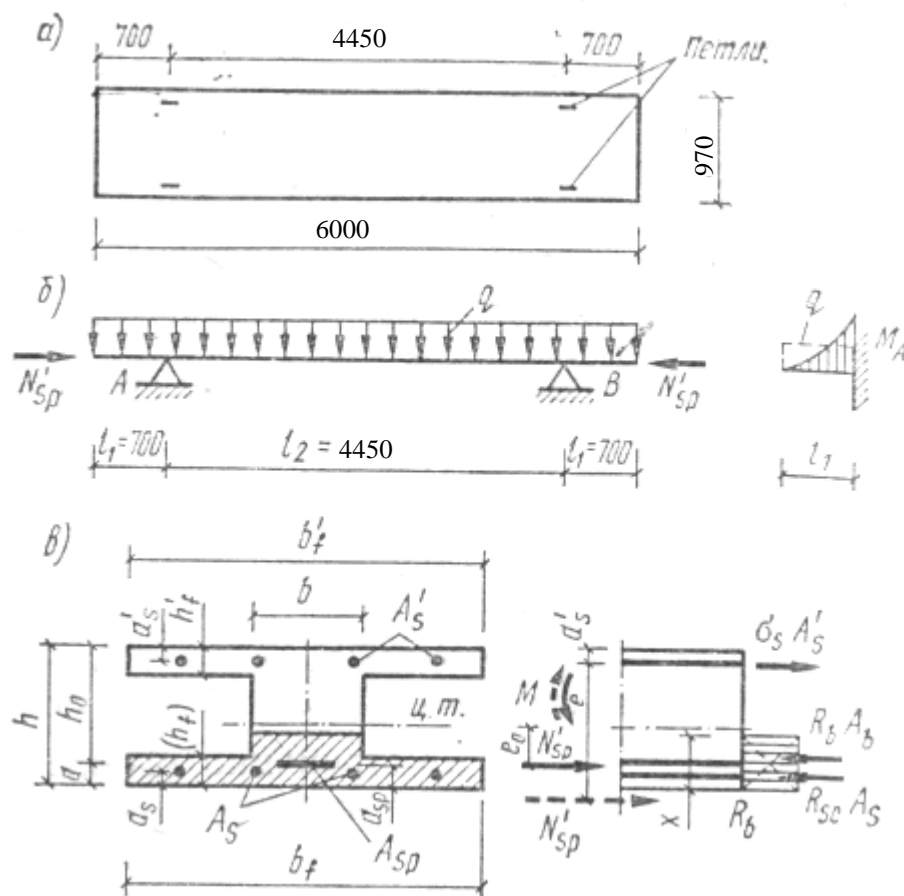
К расчету предварительно напряженной панели на монтажные нагрузки
